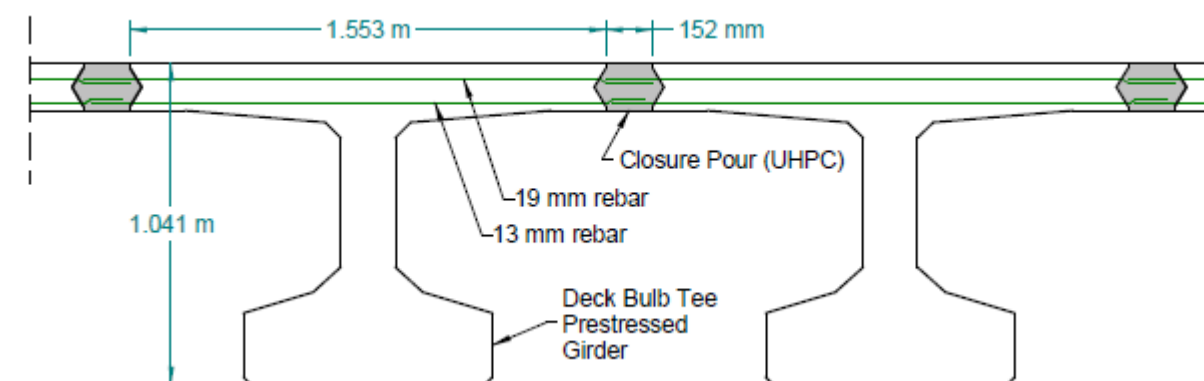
Detalle de la unión entre vigas longitudinales mediante UHPC [Graybeal 2009]
